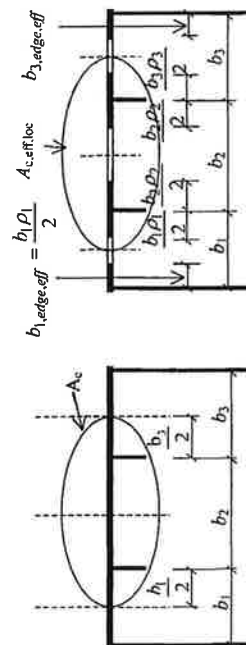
Längsausgesteiftes Blechfeld unter konstanter Druckbeanspruchung
